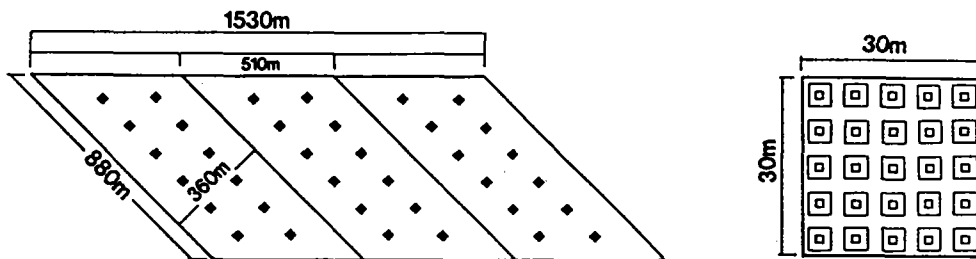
大規模場増殖場単位礁配置平面図と各単位礁の単体配置図
